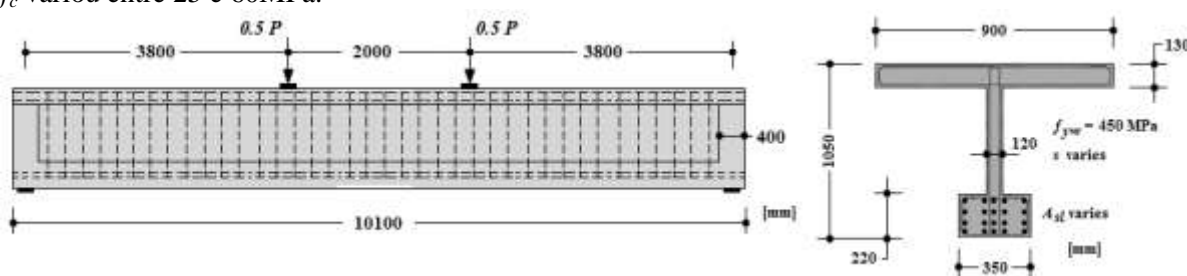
Geometria longitudinal e exemplo da secção transversal das vigas não pré-esforçadas testadas por Levi e Marro com disposição da armadura de corte e flexão.
